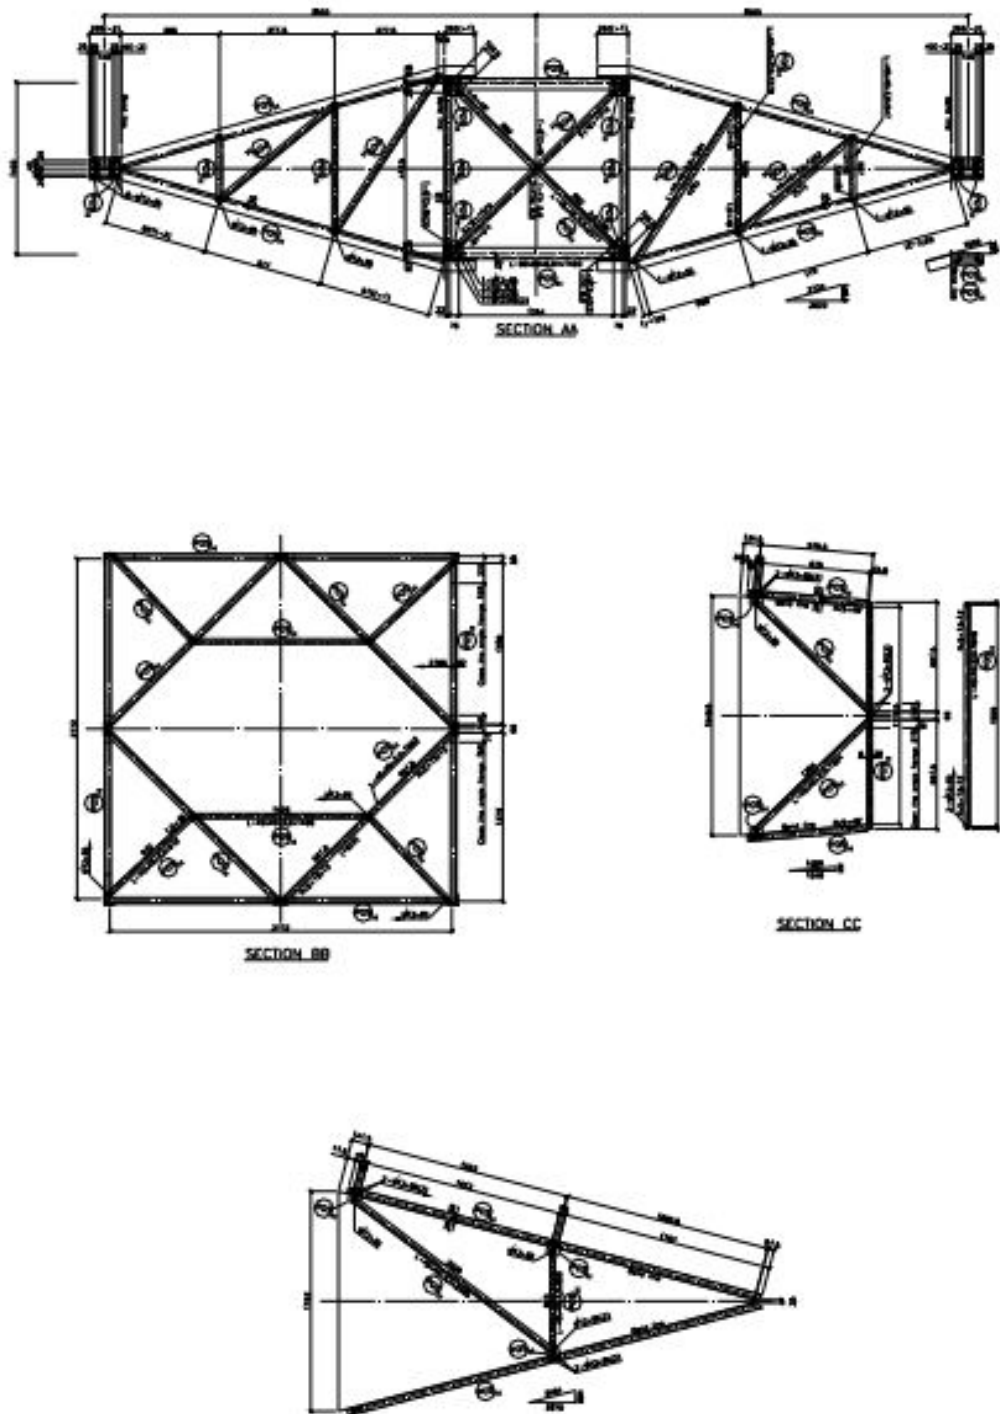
Estrutura “1”- detalhamento dos corte AA, BB, CC e vista D.
